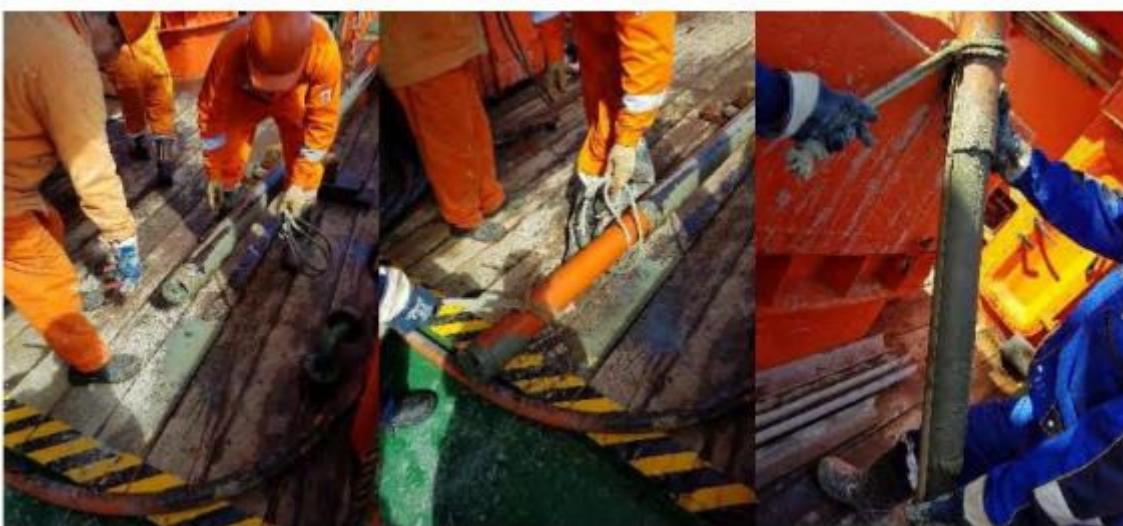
Общий вид извлечения керна из пробоотборника
